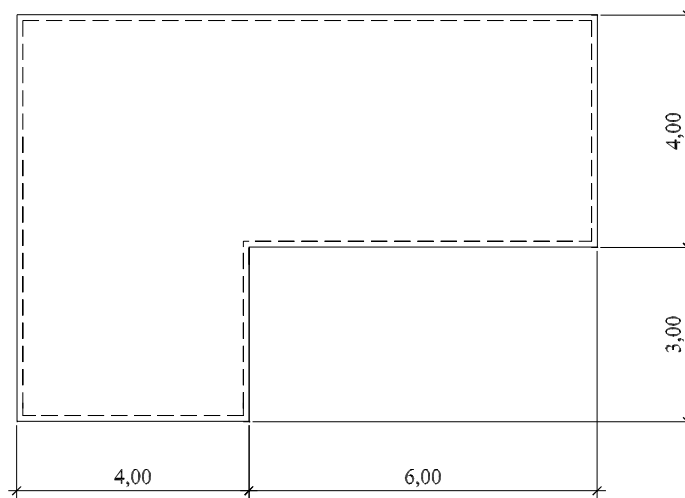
Grundriss der in Aufgabe 2 betrachteten Platte. Abmessungen in m.
